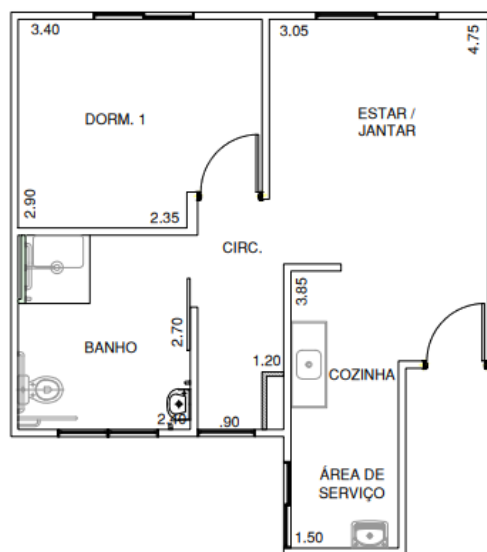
Apartamento PNE (Fonte: Construtora A)
